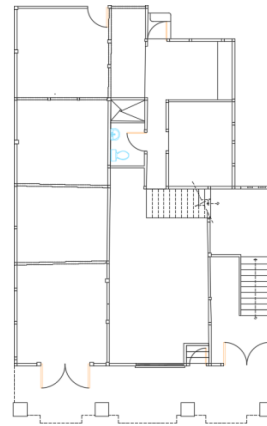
Plano de planta baja de la Casa Viteri. (INPC, 2017)
